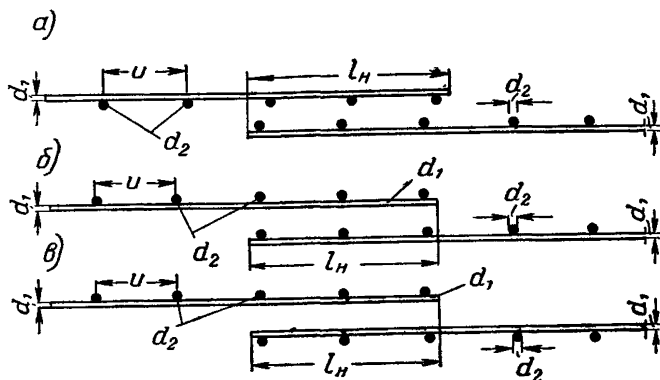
Стыки сварных сеток в рабочем направлении внахлестку, без сварки
